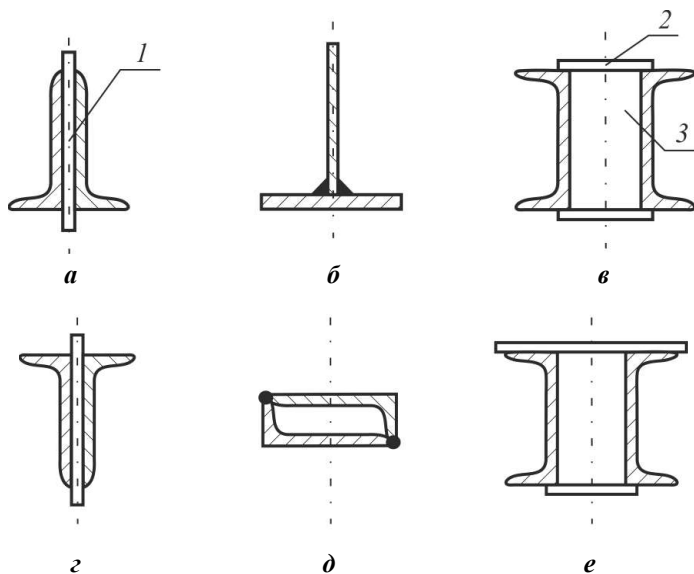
Типові поперечні перерізи зварних стрижнів ферми:
